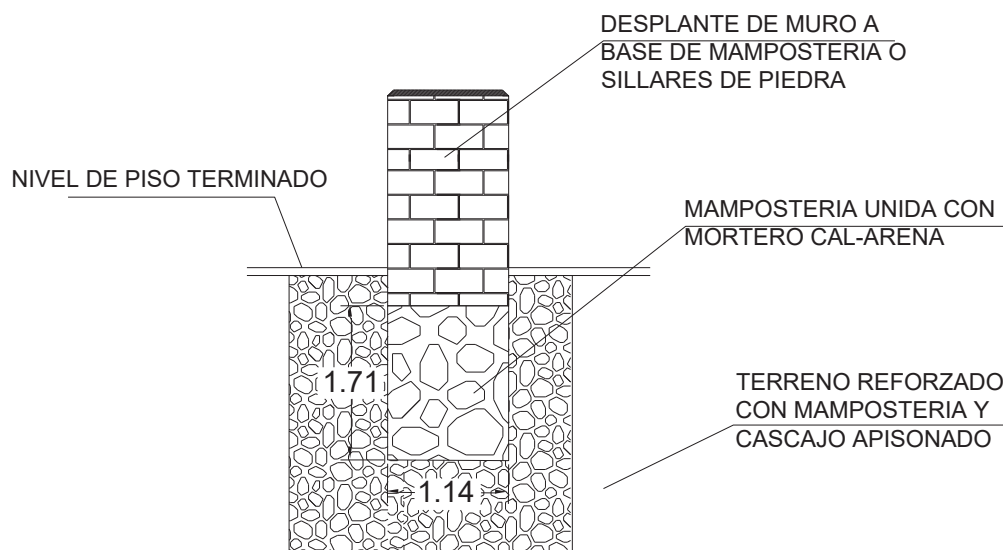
Detalle de cimentación de muros de mampostería, Juan Alberto Bedolla Arroyo, “Material didáctico de de Conocimiento Técnico Constructivo”, primer semestre, en *Especialidad en Restauración de Sitios y Monumentos*, Morelia, UMSNH, Facultad de Arquitectura, División de Estudios de Posgrado.
